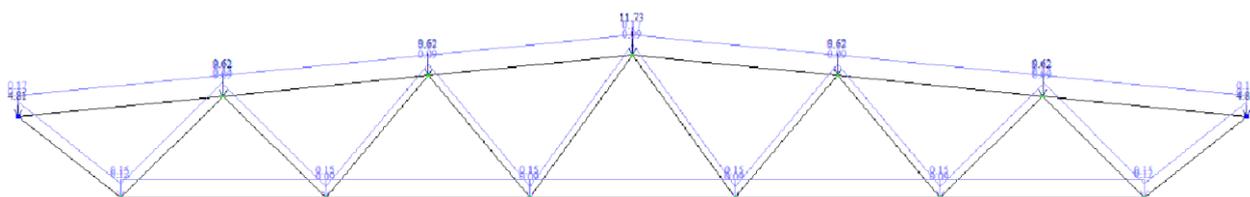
Загружение №1, от собственного веса фермы и вышележащих конструкций покрытия
